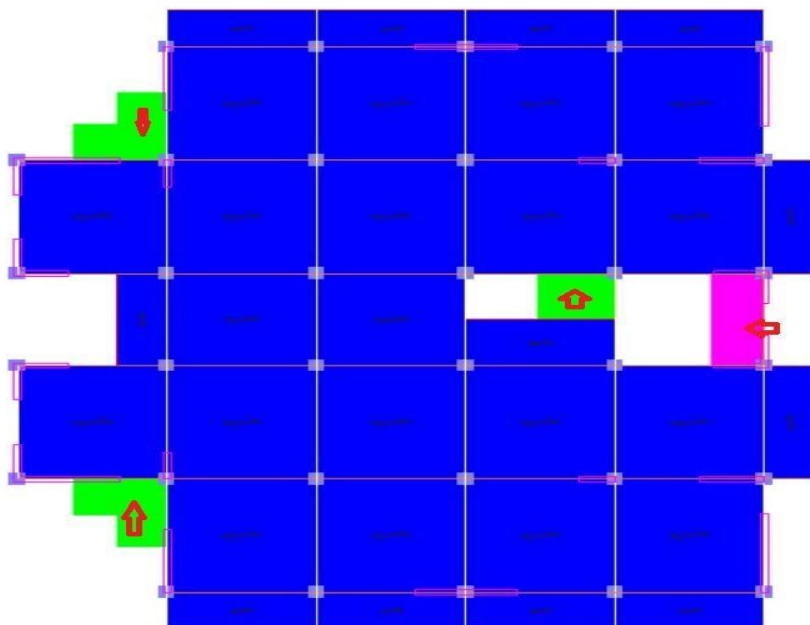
Représentation du plancher en corps creux et la dalle pleine.
